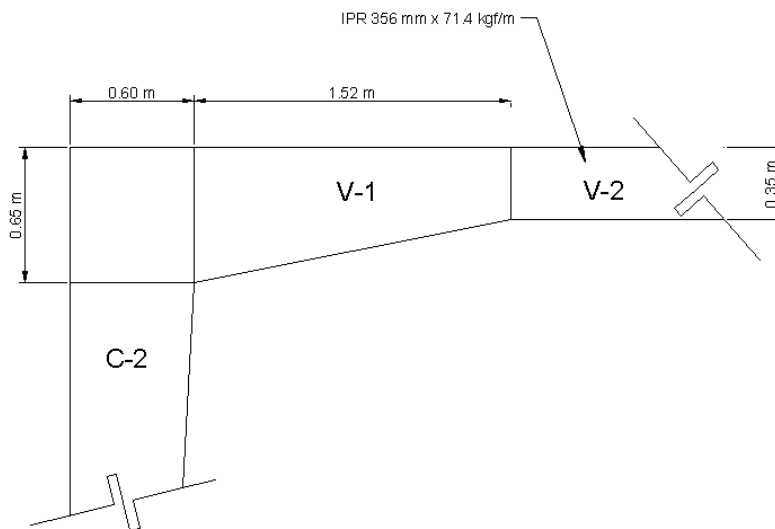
Detalle de unión entre vigas y columnas principales del puente peatonal tipo
